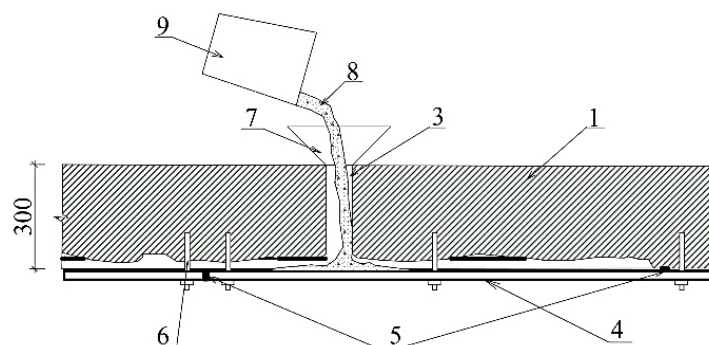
Принципова схема кріплення опалубних щитів на анкерах при способі подачі ремонтної суміші в лійку: 1 – залізобетонна плита; 2 – область пошкодження; 3 – отвір для подавання ремонтної суміші \varnothing 60 мм; 4 – опалубний щит; 5 – гумовий ущільнювач; 6 – анкерне кріплення; 7 – лійка; 8 – високорухлива ремонтна суміш; 9 – відро
